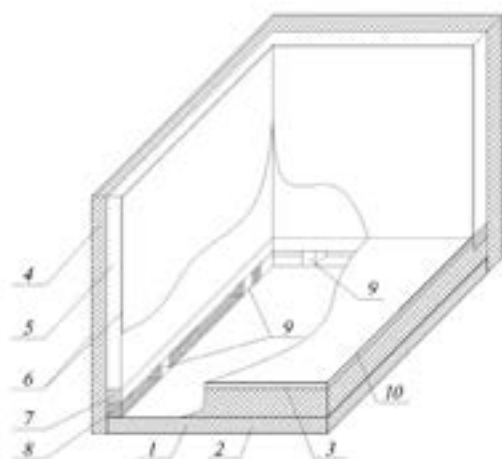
Фрагмент углового соединения наружных ограждений: 1 – монолитная железобетонная плита перекрытия; 2 – теплоизоляция; 3 – цементно-песчаная стяжка; 4 – теплоизоляция; 5 – мелкие бетонные блоки; 6 – штукатурка из цементно-песчаного раствора; 7 – железобетонная балка; 8 – утеплитель; 9 – локальные опоры из армированного бетона; 10 – линолеум. *Примечание.* Чтобы показать размещение локальных опор и балки, некоторые части ограждений условно не показаны
